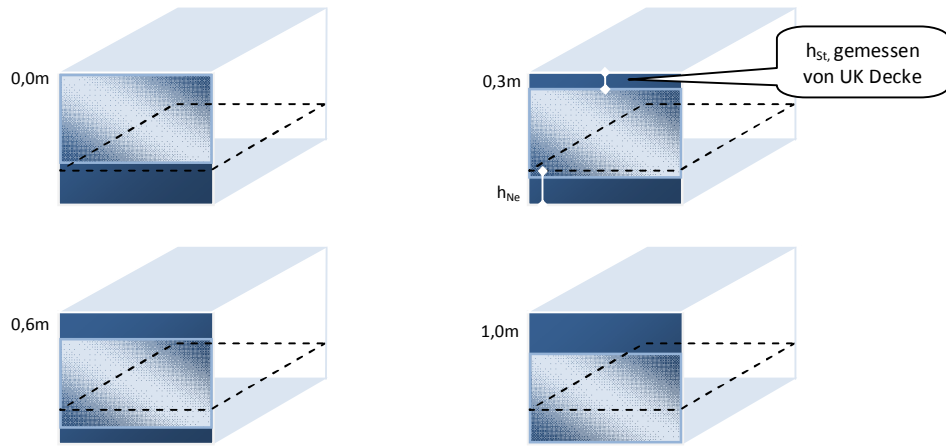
Varianten verschiedener Fensterpositionierungen in der Fassade, Fassadenansicht
